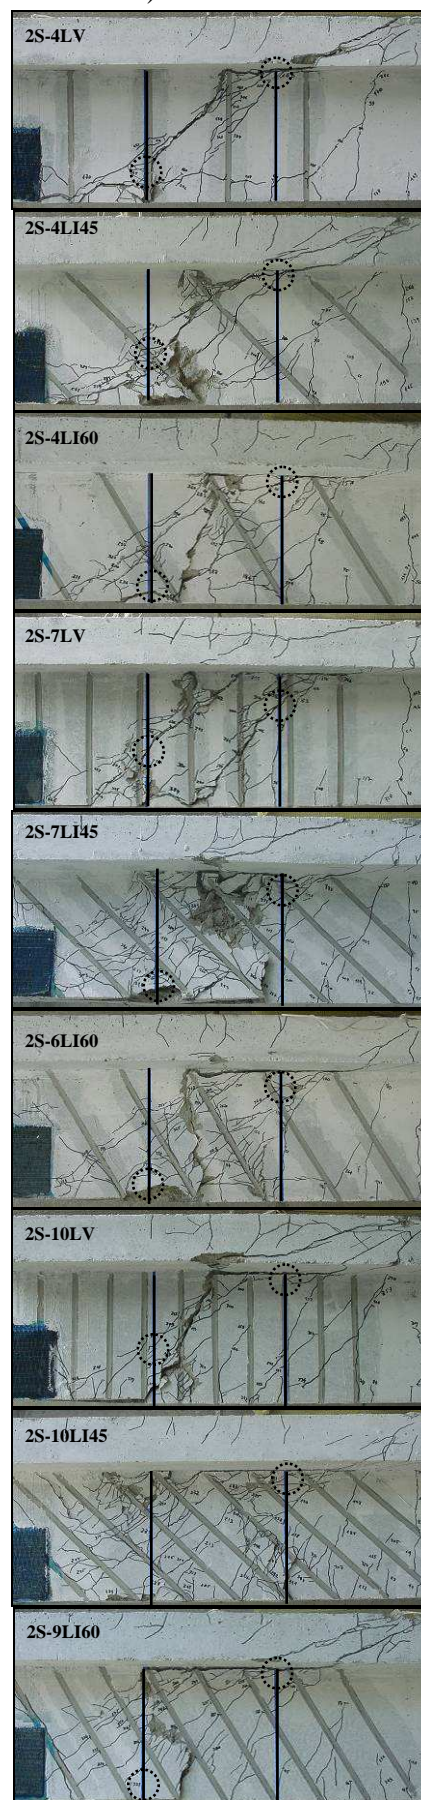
Modos de rotura das vigas com CFRP (NSM).
